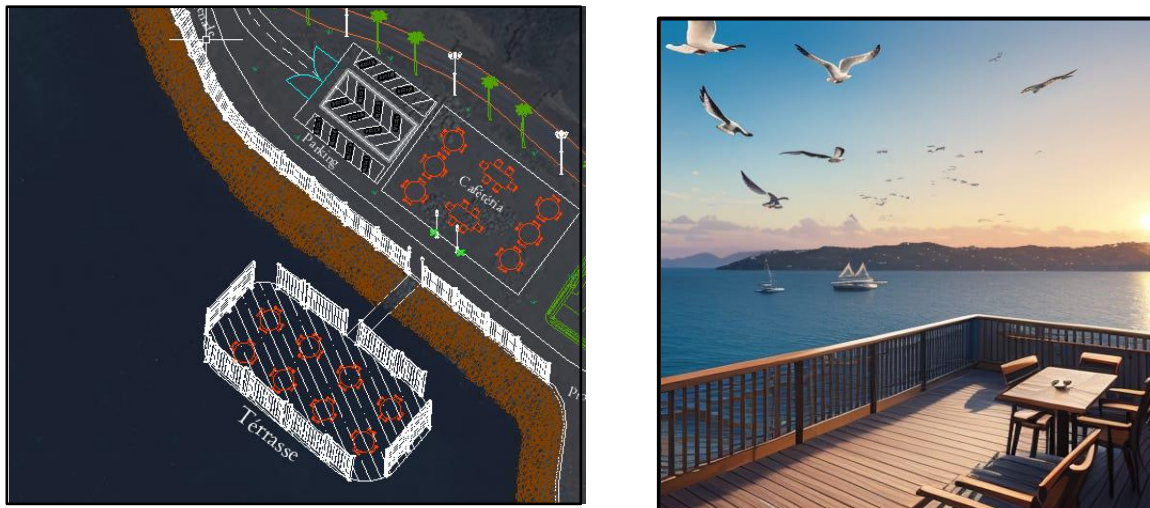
Coupe technique AutoCAD de la cafétéria, la terrasse flottante et le parking avec une image générée par le AI
